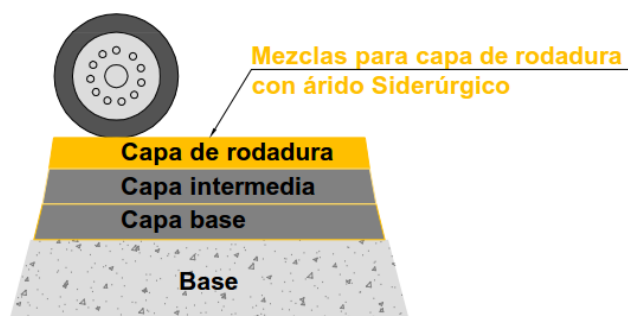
HORMIGÓN BITUMINOSO EN PAVIMENTOS FLEXIBLES.
